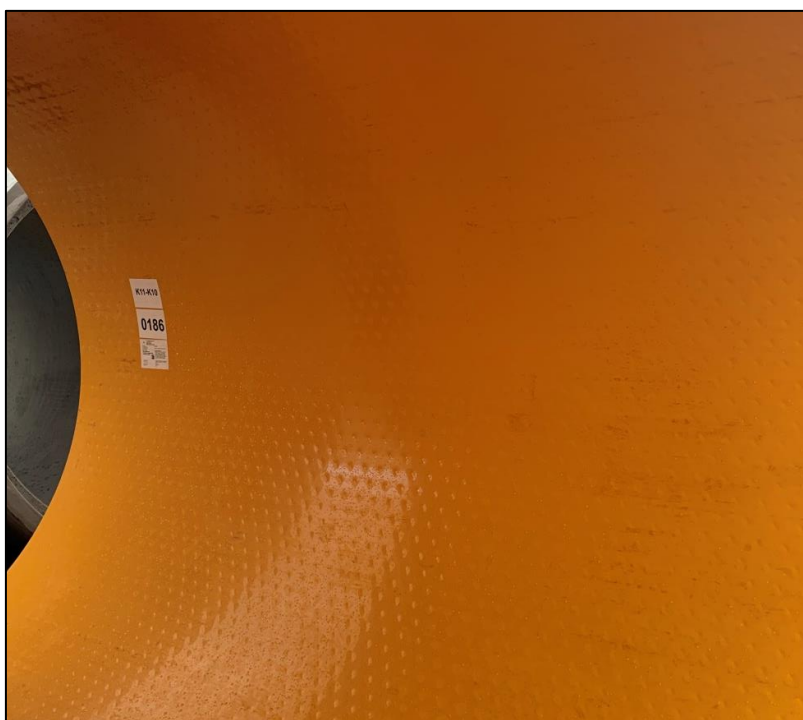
widok wykładziny PEHD od strony betonowania
